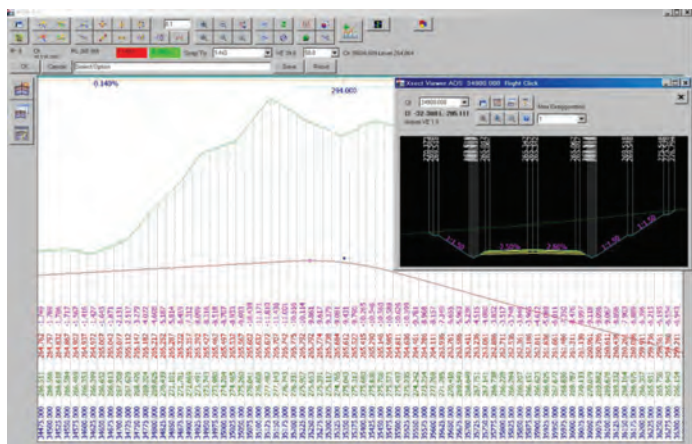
Vizualizare profil longitudinal și secțiune transversală
